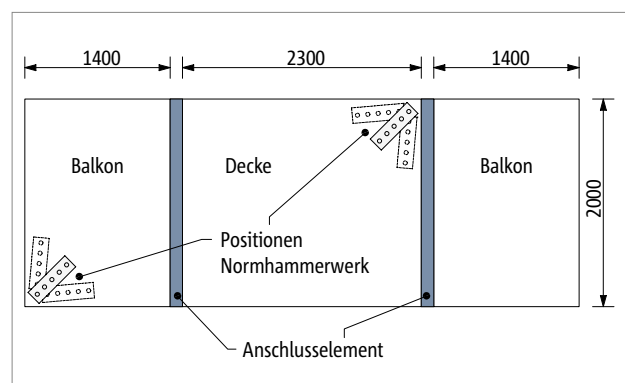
Prüfaufbau nach EAD 01 (adopted), Grundriss
